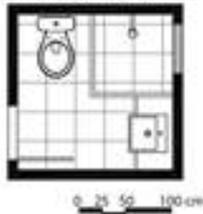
Sugestão de planta baixa do banheiro nº 2.
